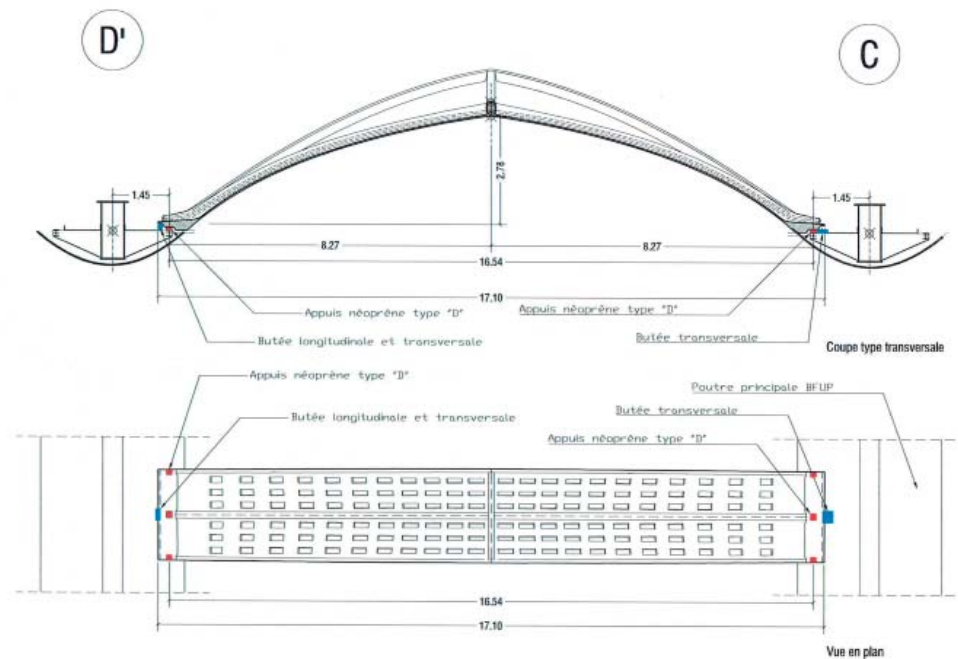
Secció longitudinal i planta d'una placa d'UHPC.
